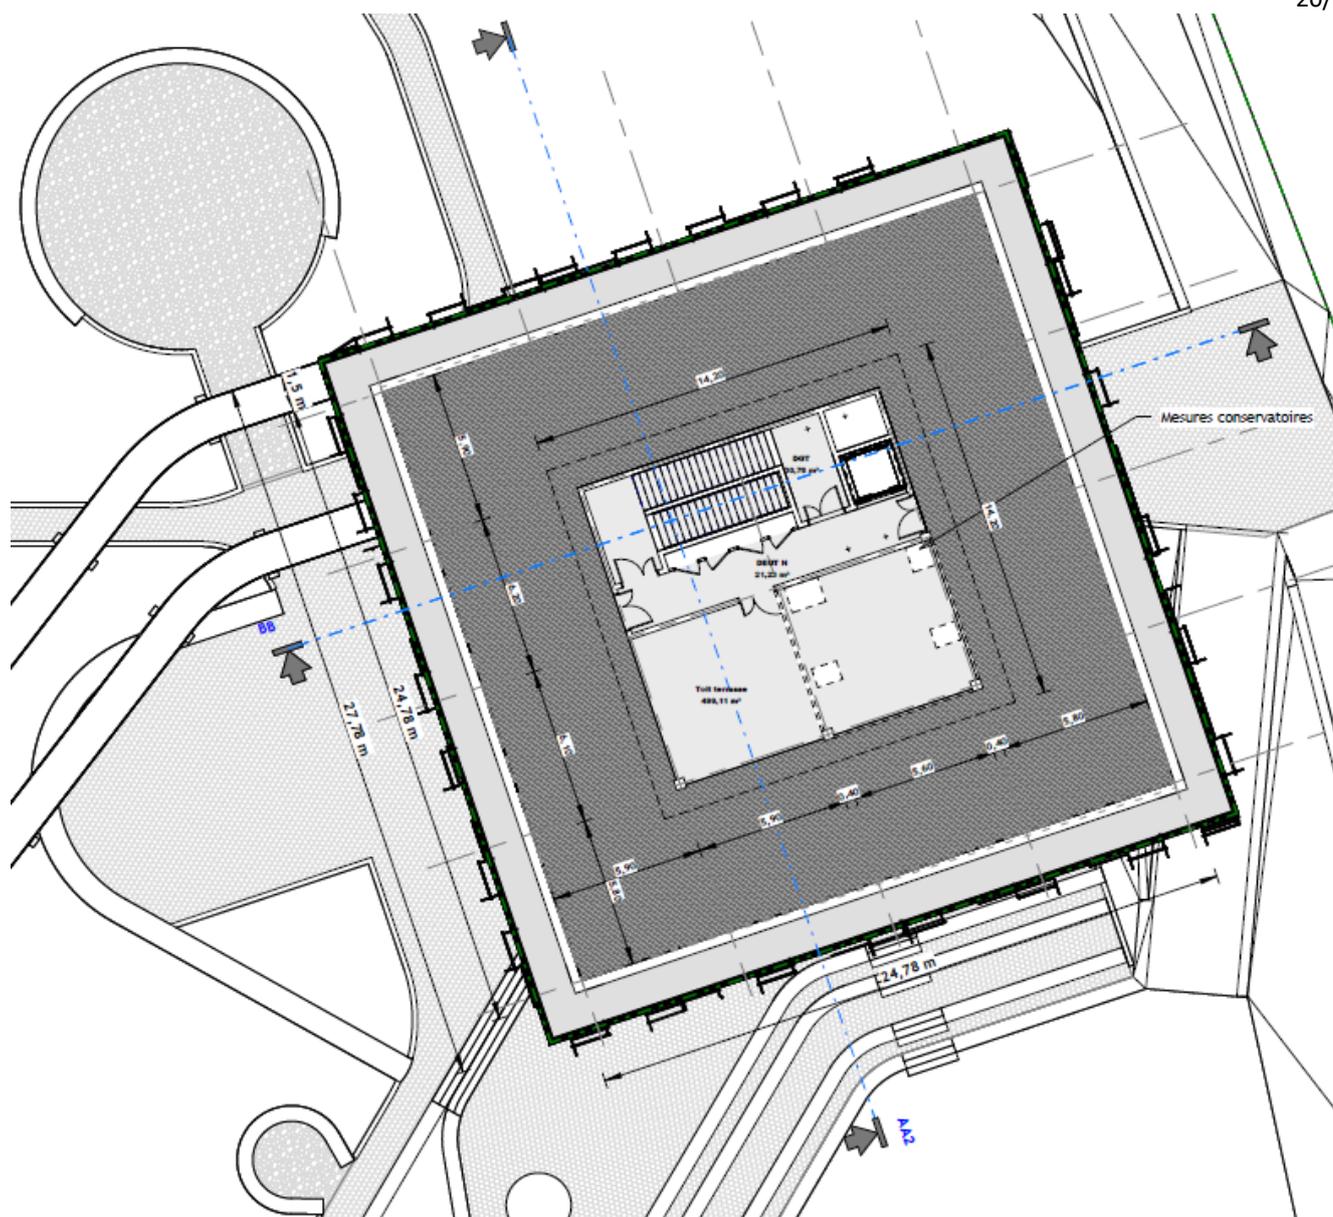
Plan de pavillon – niveau R+5 - toit terrasse (février 2024)
